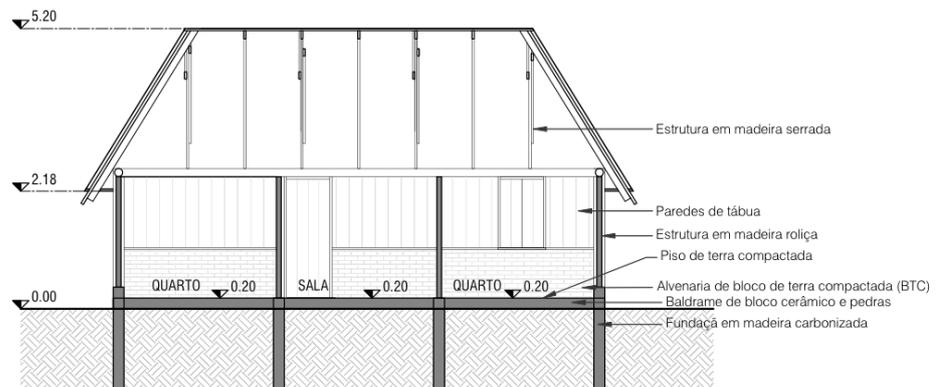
Planimetria de casa Kubêngôkre para aldeia Apetí em proceso, Projeto Coletivo Kikré, 2017. Fuente: Estúdio Guanabara.
